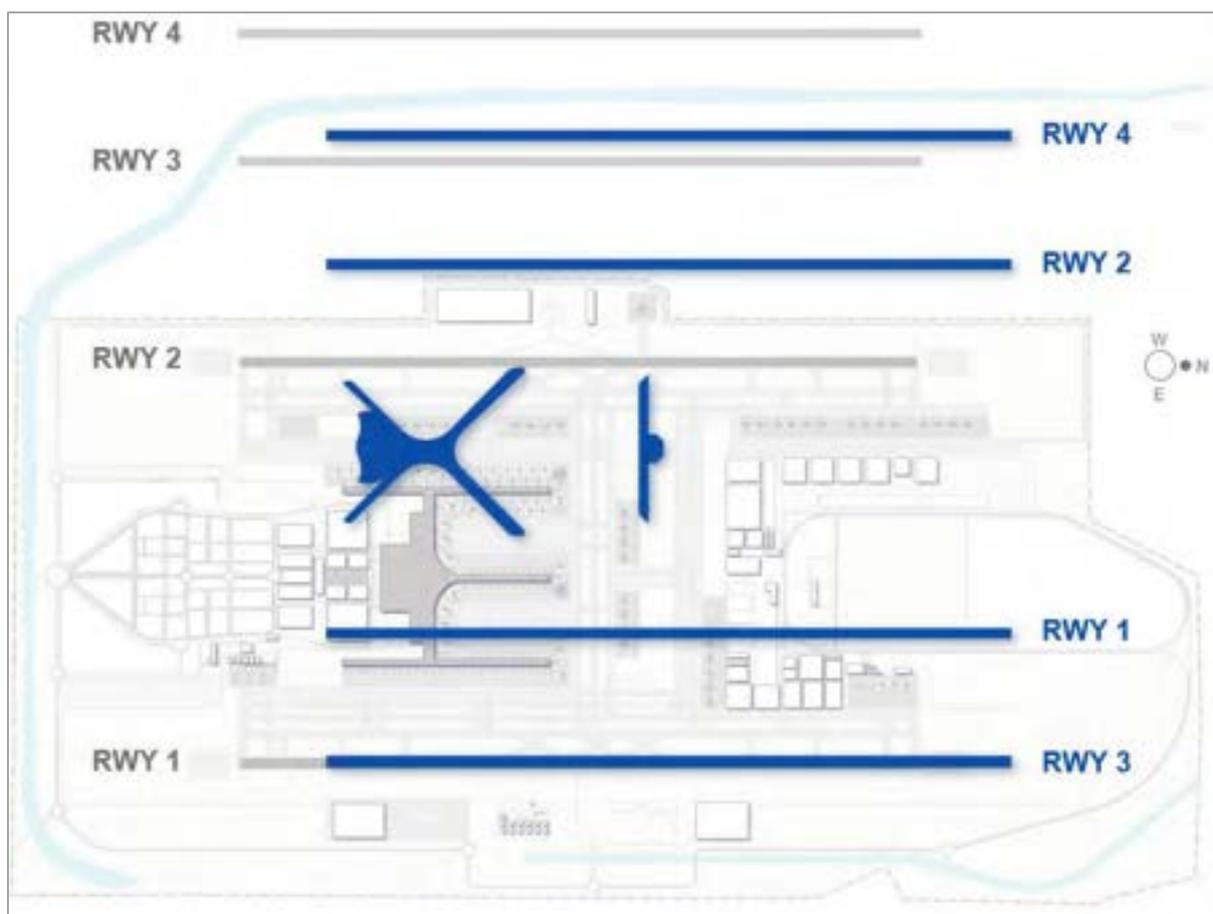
Comparação entre o novo Plano Diretor e o plano de 2009.
